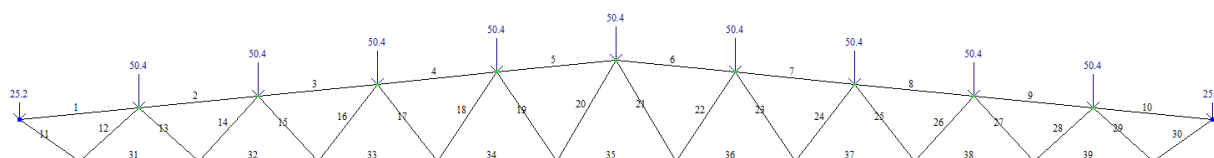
Схема загрузкиения фермы временной кратковременной нагрузкой
